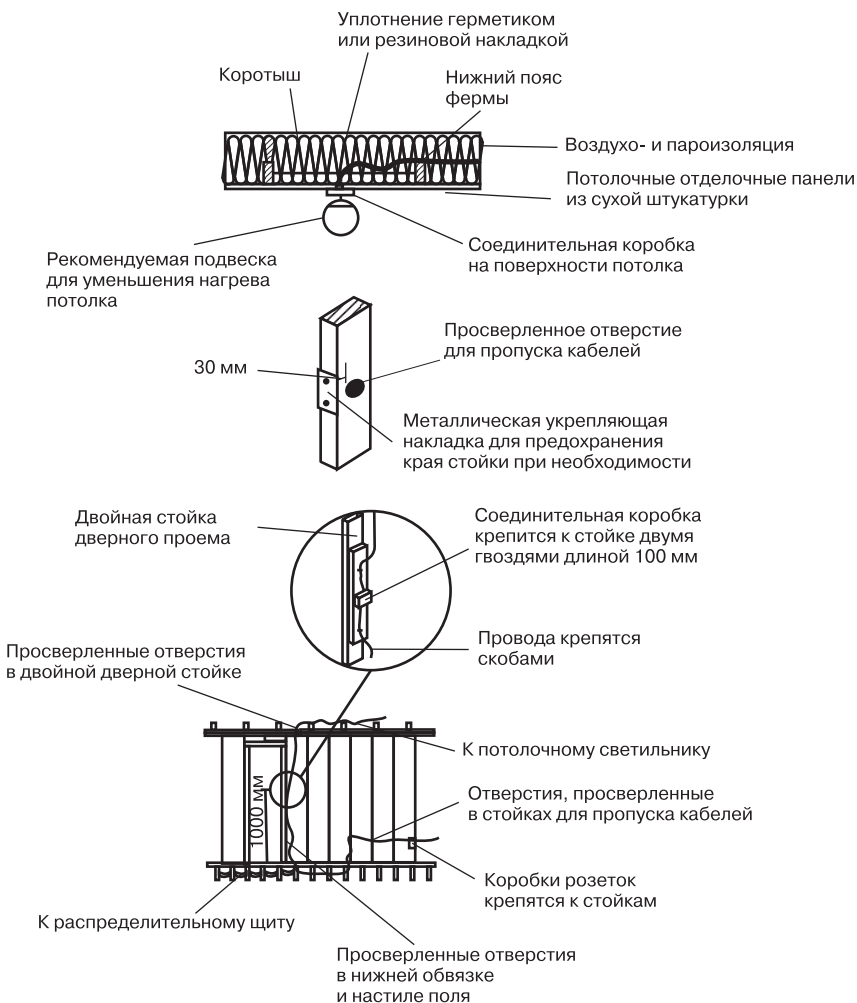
Прокладка электрических проводов в элементах каркаса
